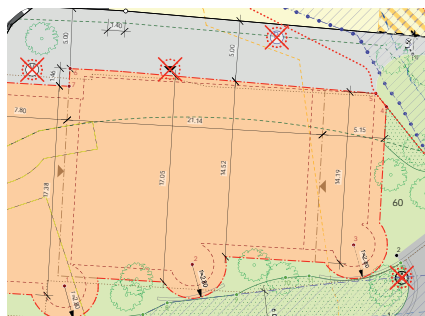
Ausschnitt Überbauungsplan: Entfernte Hinweise sind in Plan und Legende rot durchgestrichen dargestellt.
